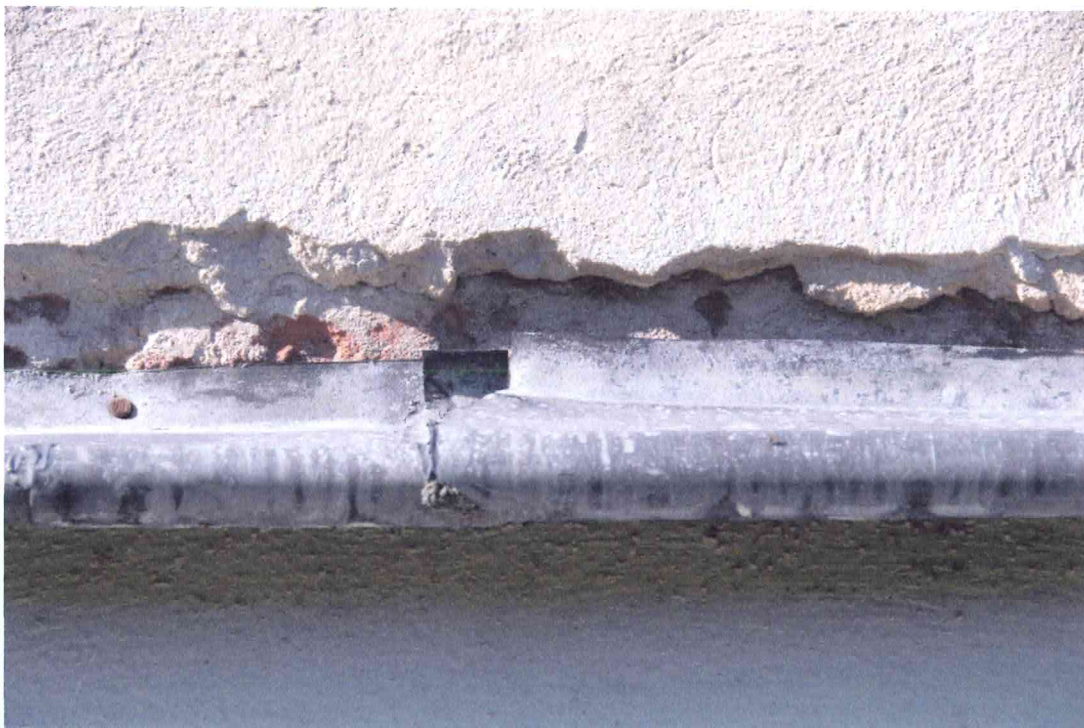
Radzyń Podlaski, Pałac Potockich, skrzydło wschodnie, elewacja zachodnia, fragment, stan przed konserwacją, październik 2008 r.
